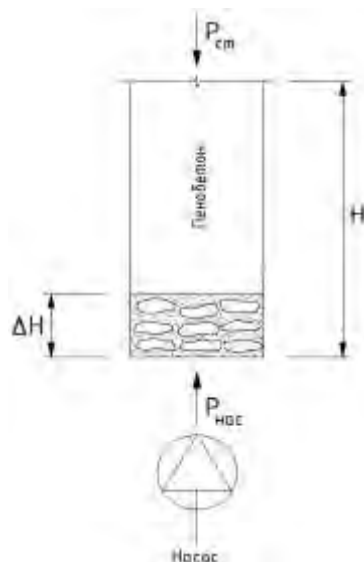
Схема воздействия различных видов нагрузки на нижние слои пенобетона при вертикальной транспортировке
